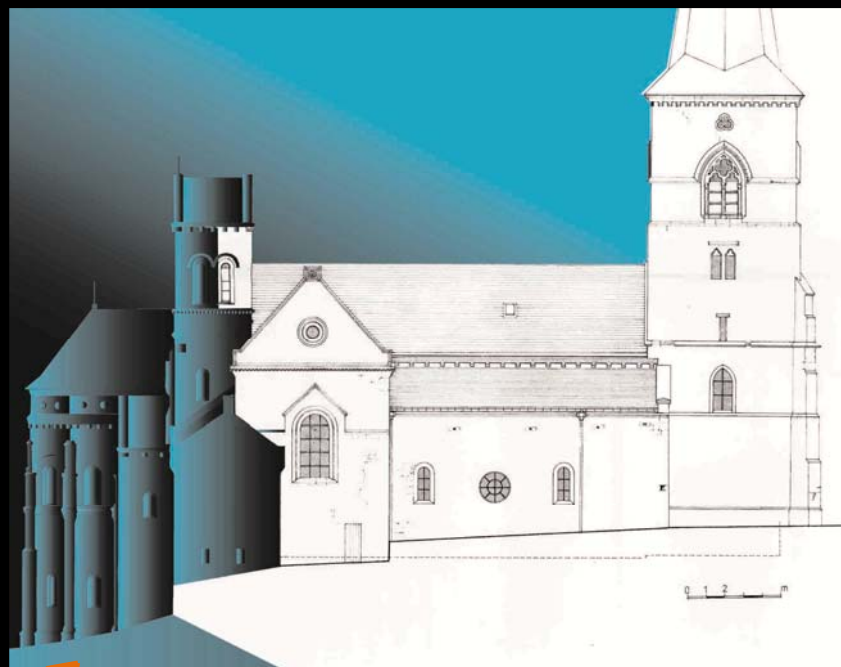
Technique de retraçage des facettes à partir du plan façade
